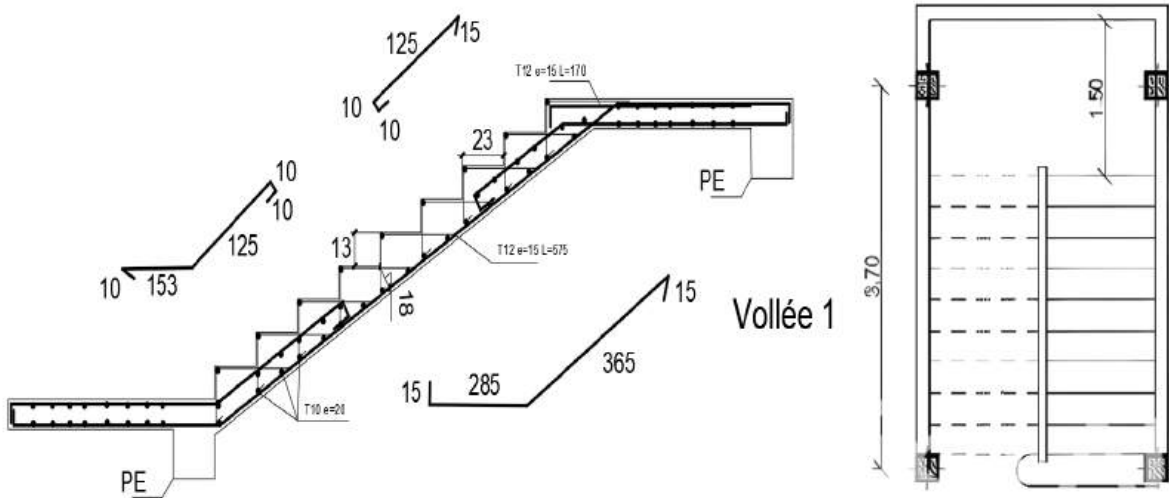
Schéma du ferrailage de la volée de l'escalier
